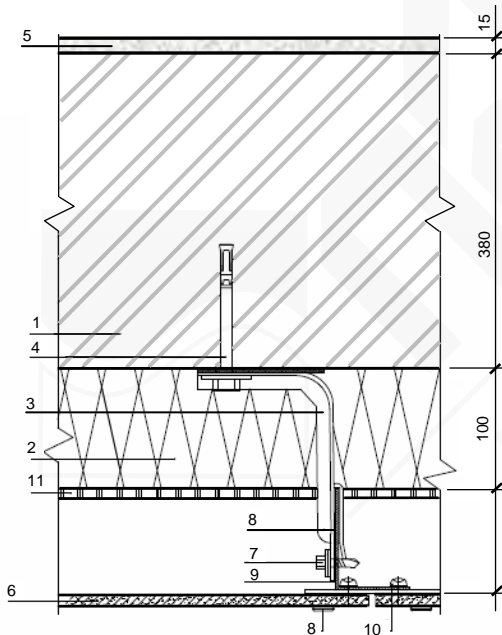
Схема наружной стены с навесной фасадной системой «ВФ МП КВ»:
